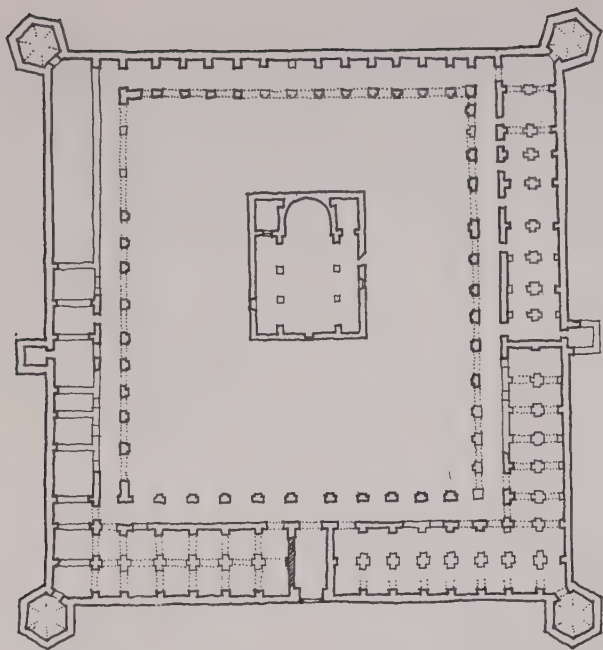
Castrum* di Al-Andarīn: Planimetria
